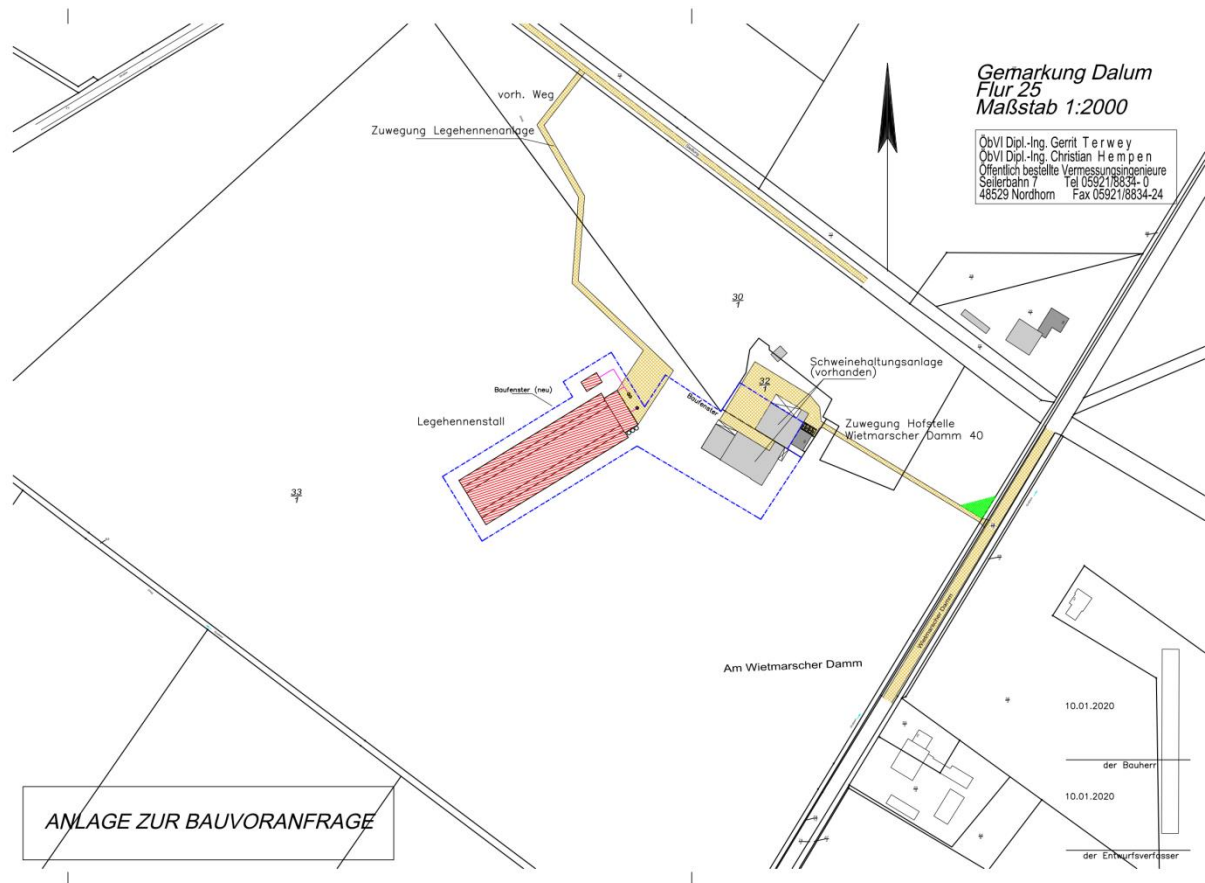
Lageplan der geplanten Anlage (Vorentwurf)
